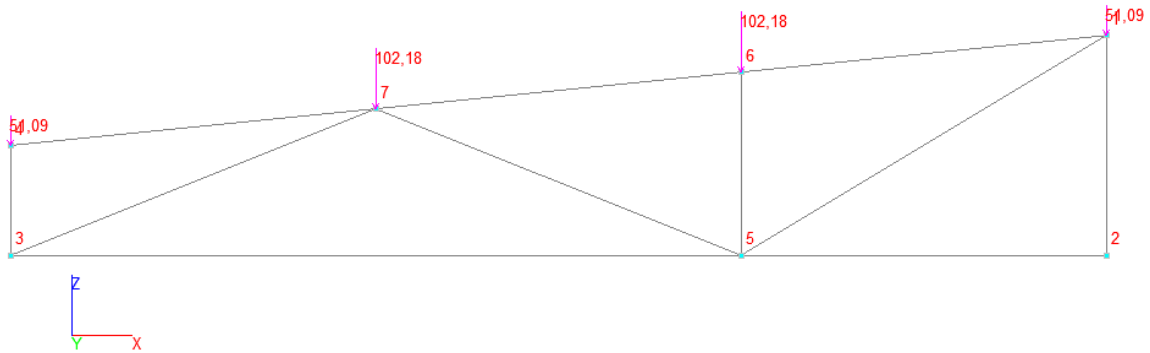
Кровляна ферма 9 м в комплексі SCAD ++
